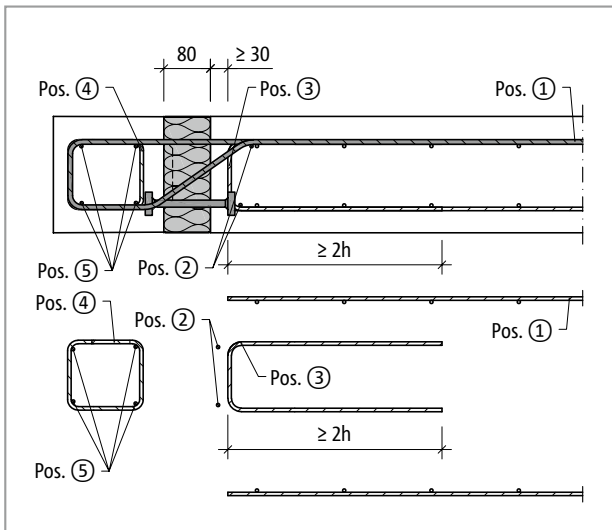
Schöck Isokorb® T Typ O: Bauseitige Bewehrung
